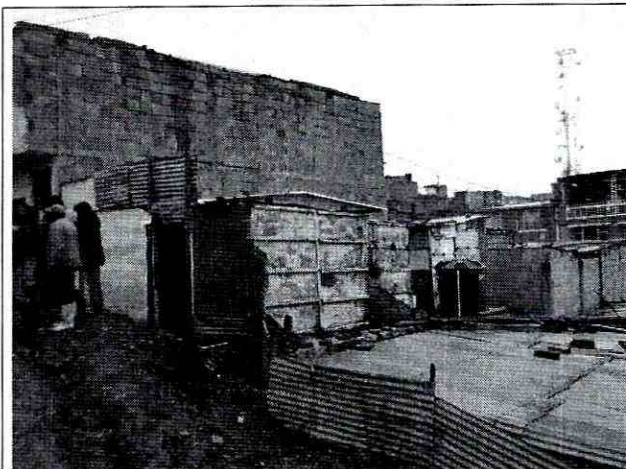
Vista de fachada de la vivienda ubicada en la Carrera 75 D # 75 F- 54 Sur.
